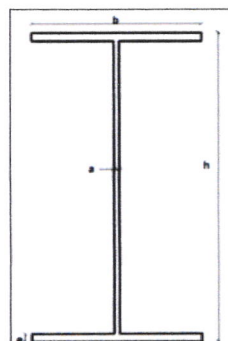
poutre IPN 400 ; source auteurs 2018.
